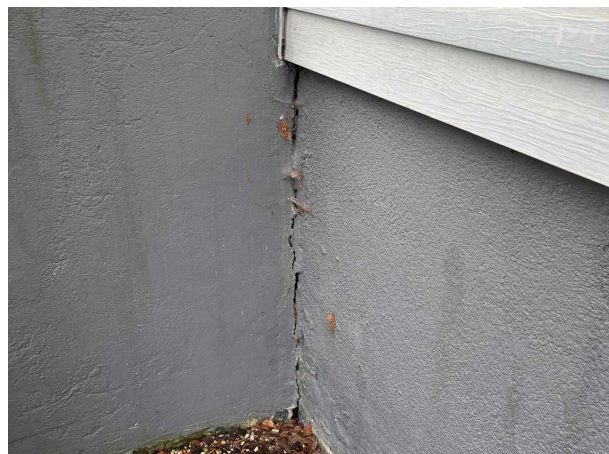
Utvändigt, Fasad, Betongkonstruktion av typ entrétrappa noteras mot fasad/stomme..
